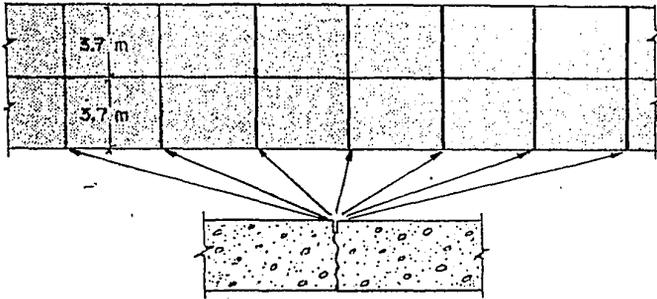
PAVIMENTO DE CONCRETO SIMPLE, JUNTAS DE CONTRACCION SIN REFUERZO
